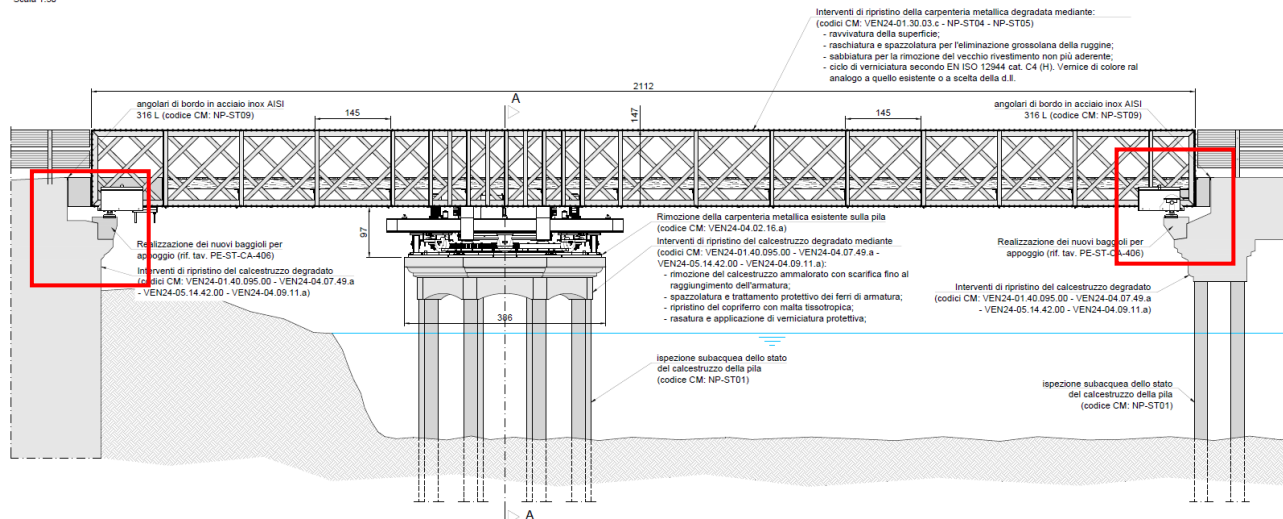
Prospetto con individuazione dei baggioli di appoggio.
